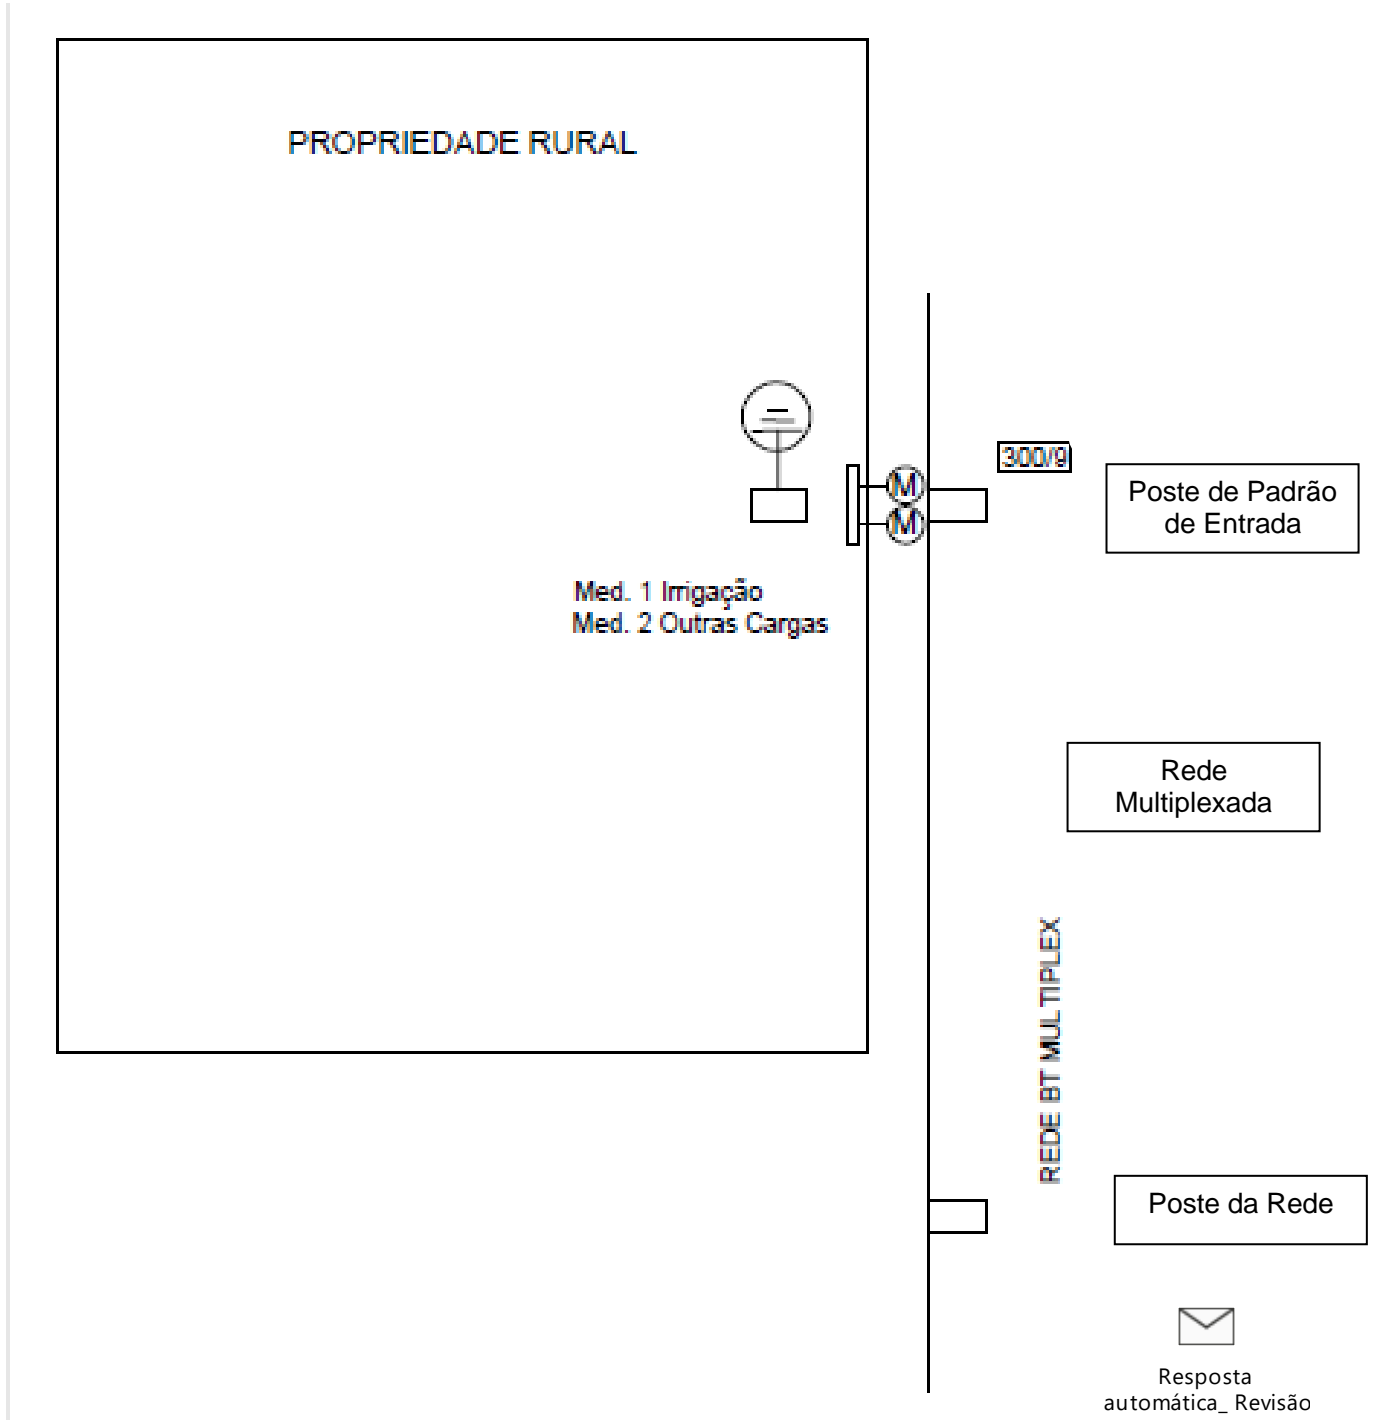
Instalação para Fornecimento Provisório – Vista Superior
